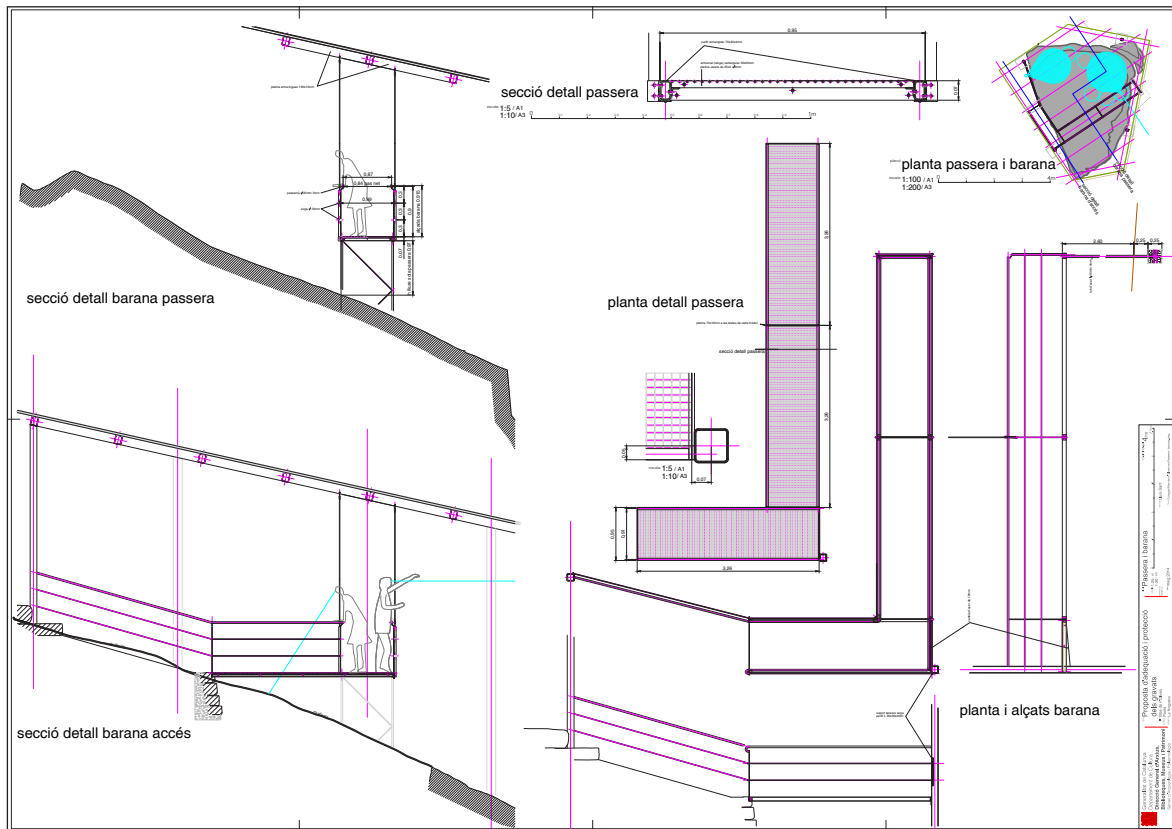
Plantes, seccions i detalls de la passera i la barana.
